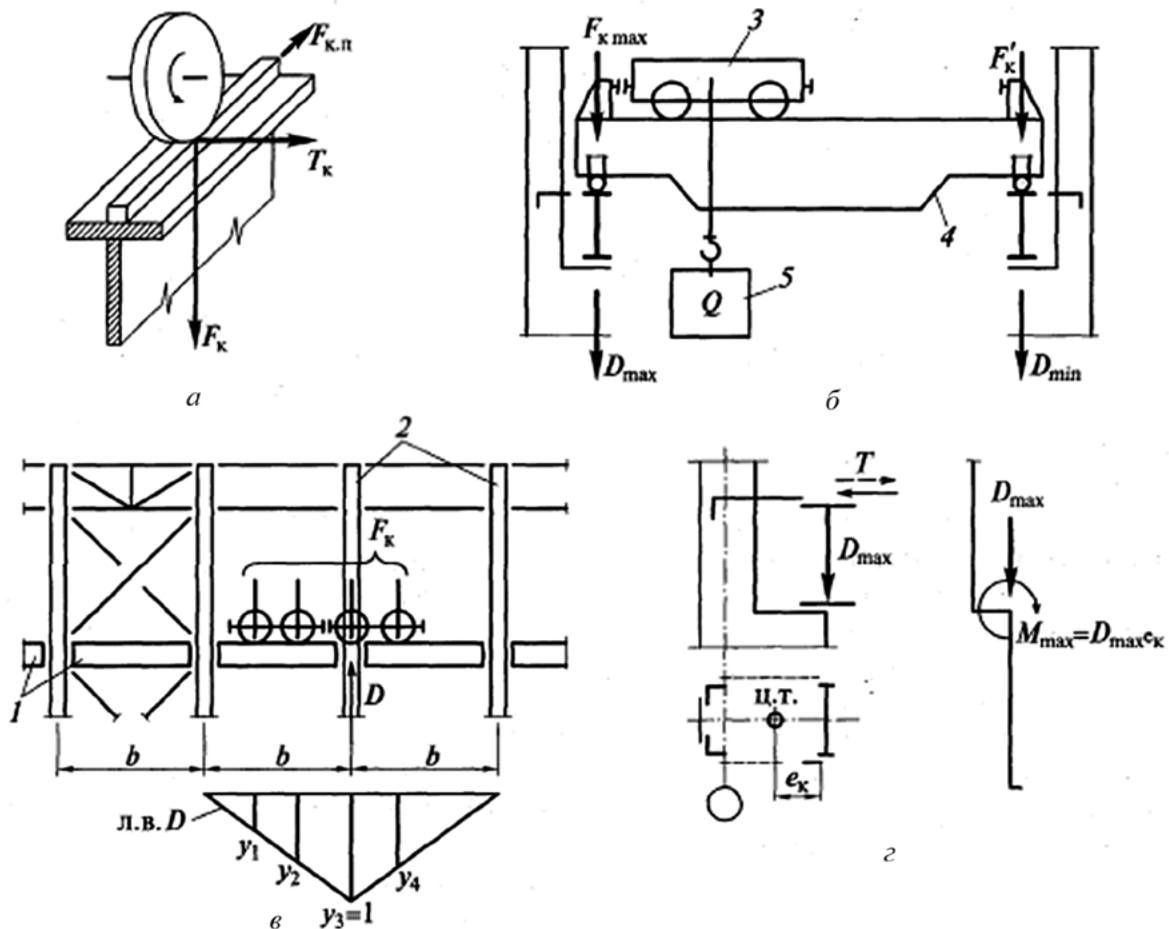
К определению нагрузок на раму от мостовых кранов:
